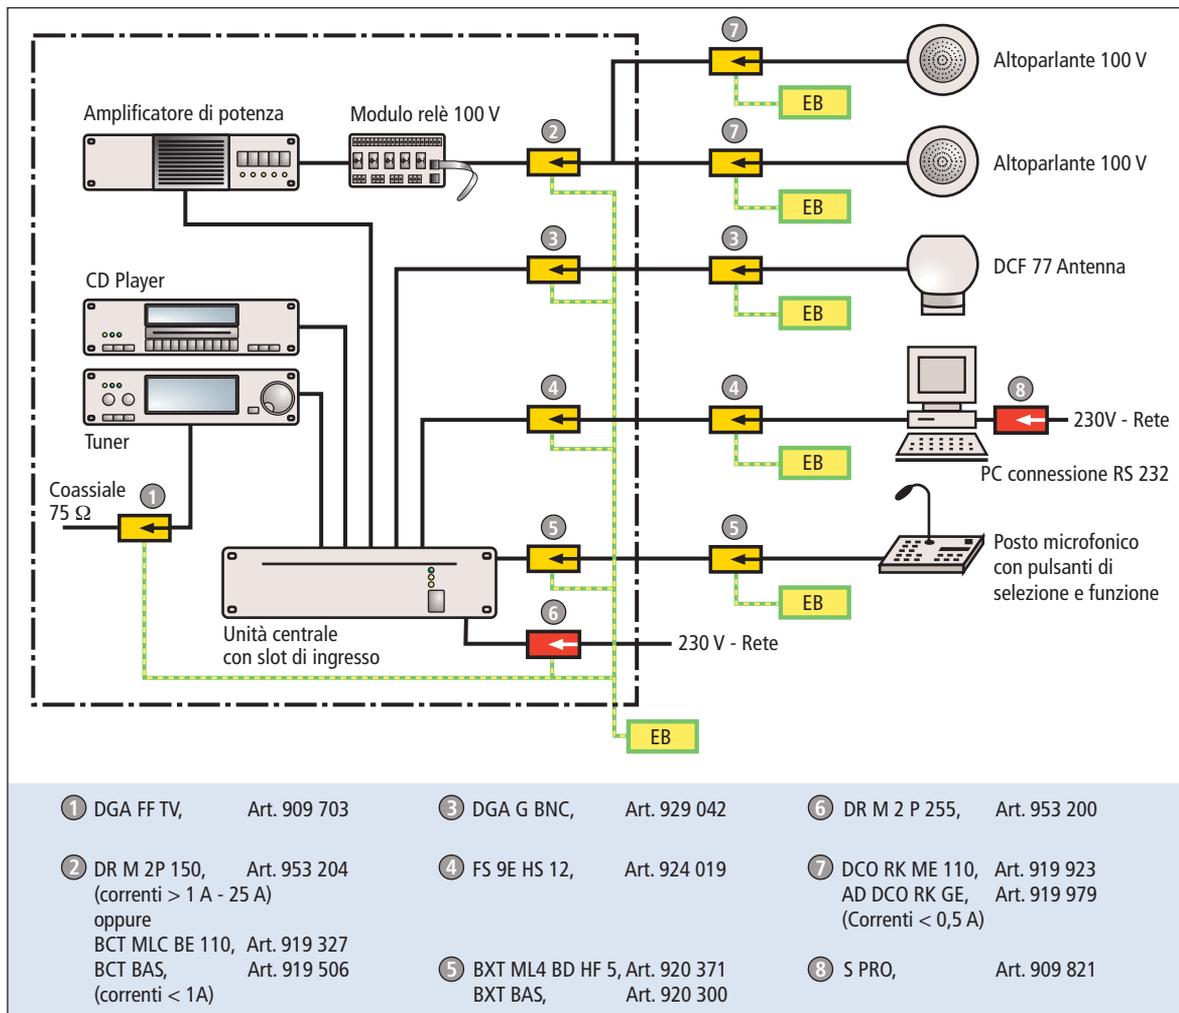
Impianto elettroacustico modulare con dispositivi di protezione da sovratensioni
